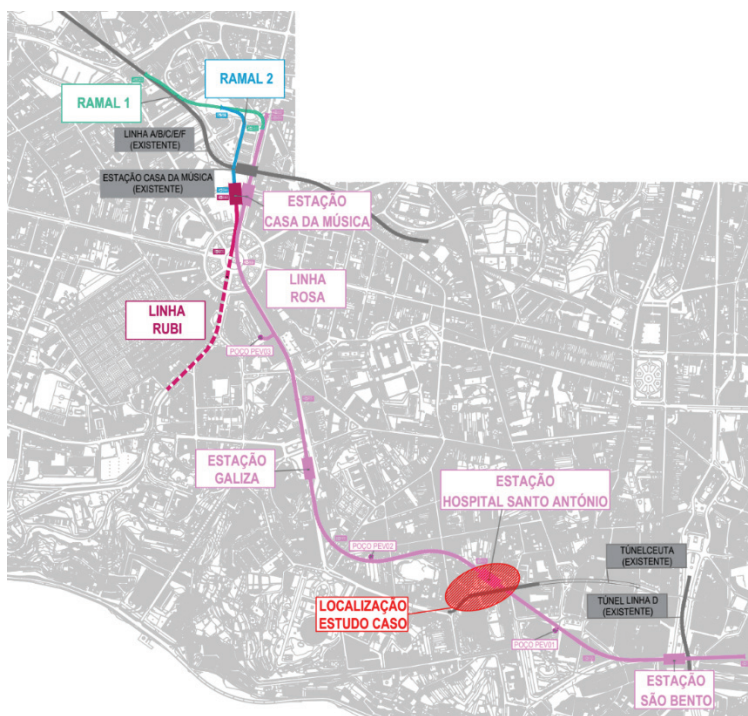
Planta com a localização do caso de estudo (adaptado de Sener/CJC/NSE, 2020).
